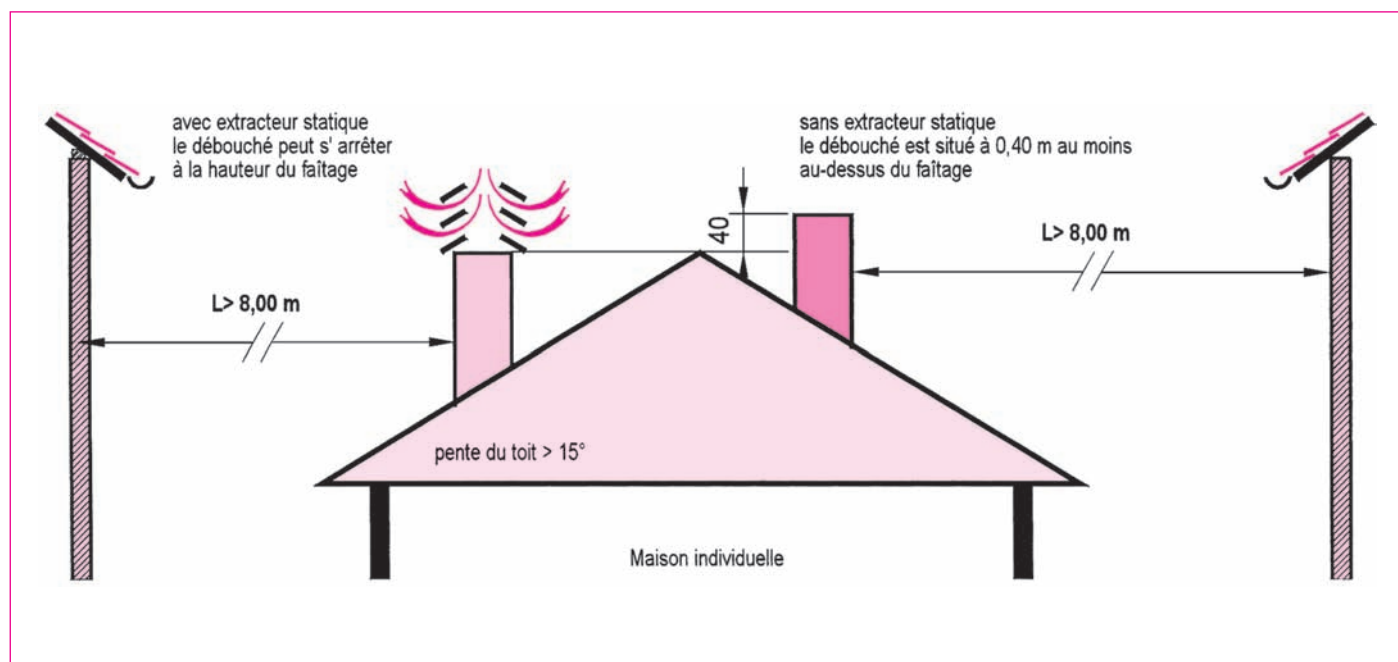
Débouché de la souche en toiture de pente > 15°
